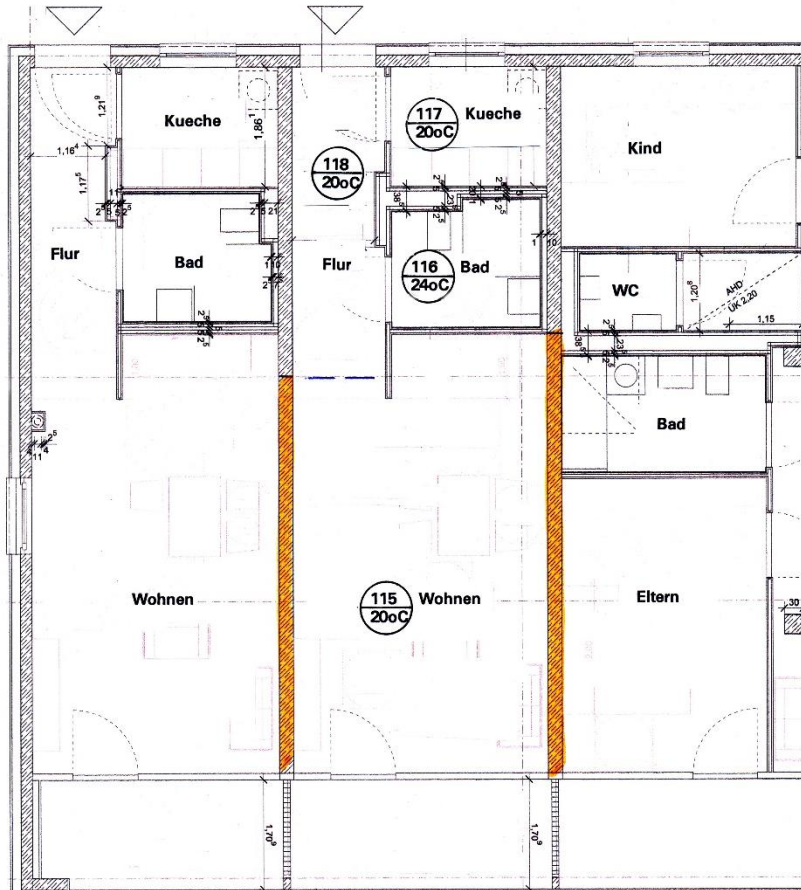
Grundriss 1.OG mit Raum 115
